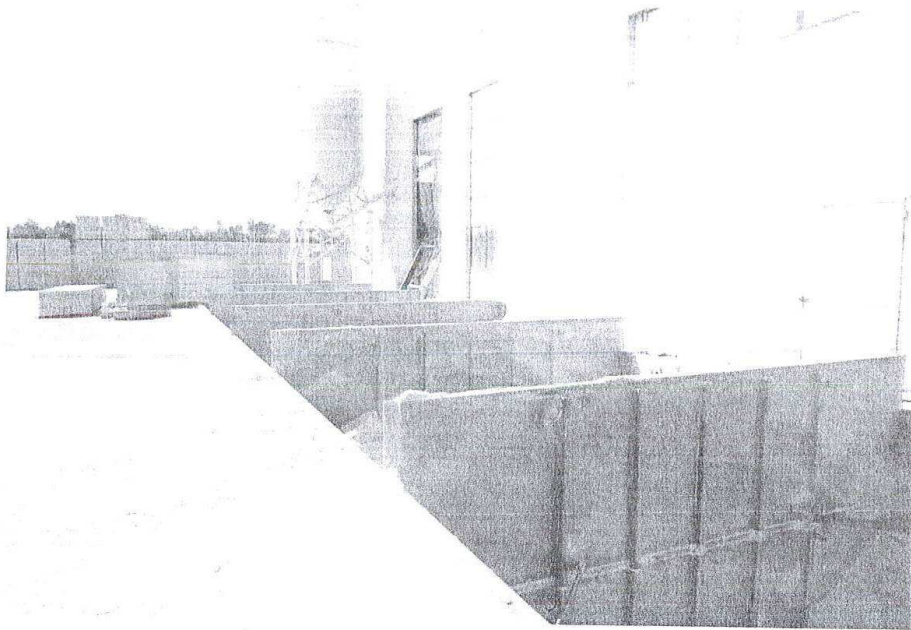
prospetto laterale ZONA VASCHE in primo piano.
